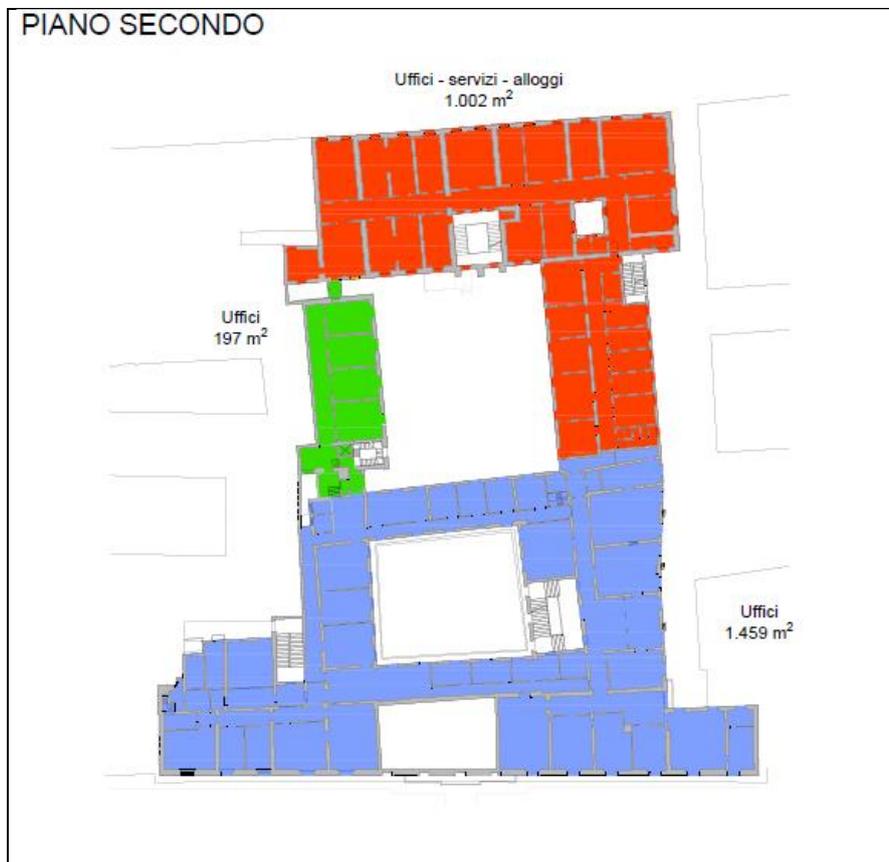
Piano di razionalizzazione – Riallocazione Amministrazioni (piano secondo)
